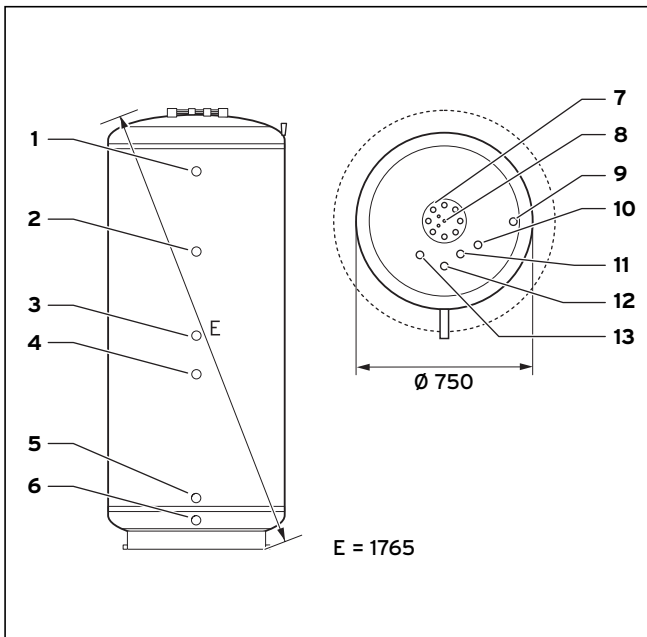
Монтажный размер при опрокидывании комбинированного водонагревателя auroSTOR (мм)
